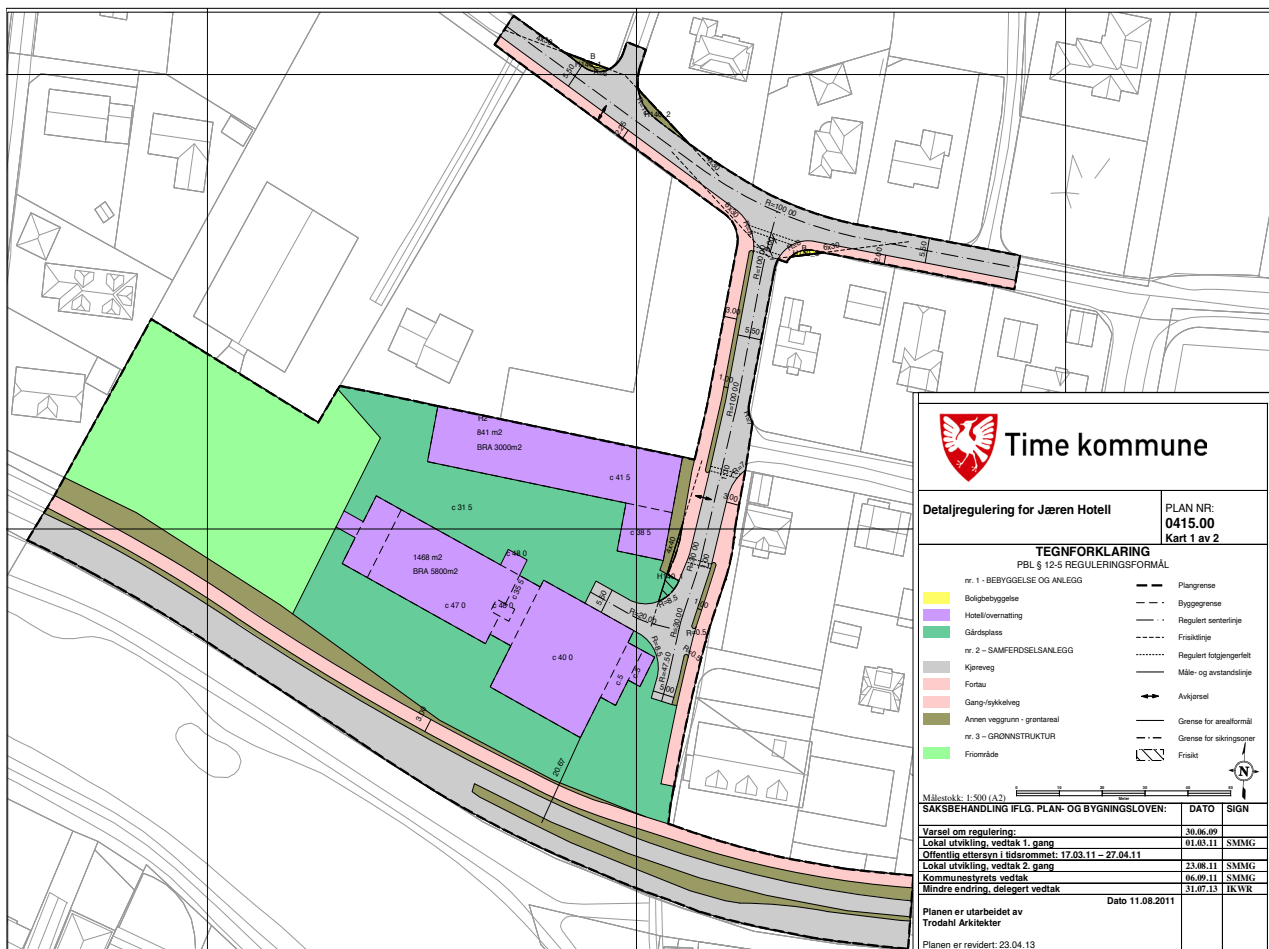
Plan 0415 Detaljregulering for Jæren hotell
